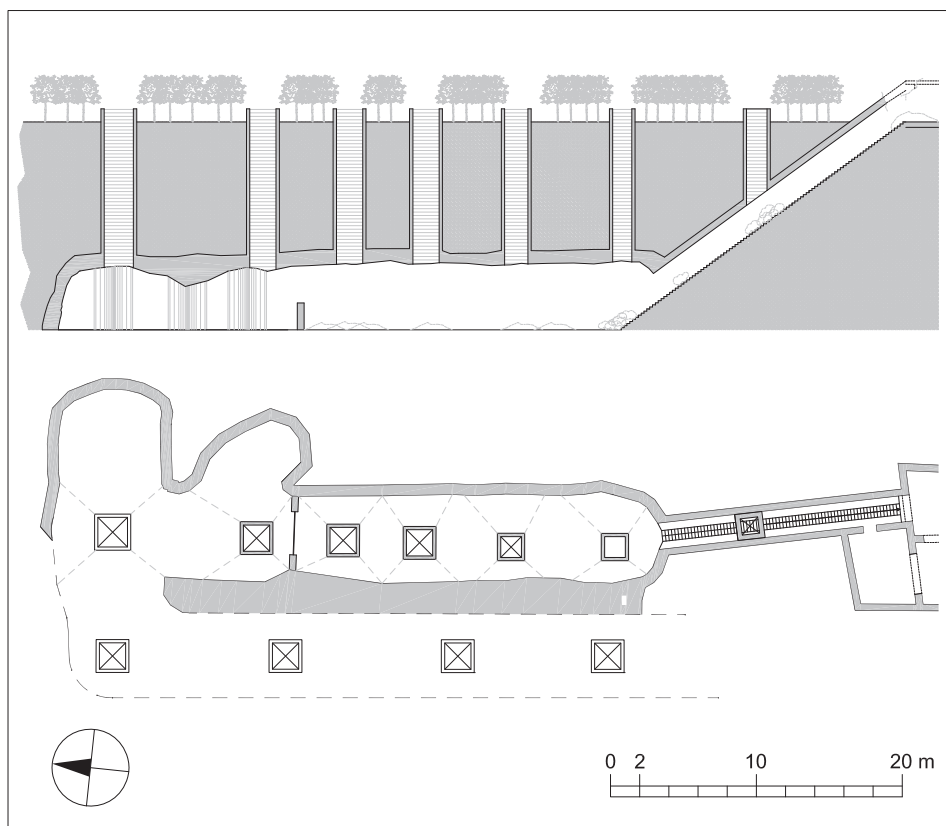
Gallo, cantina C11. Pianta e sezione longitudinale.
